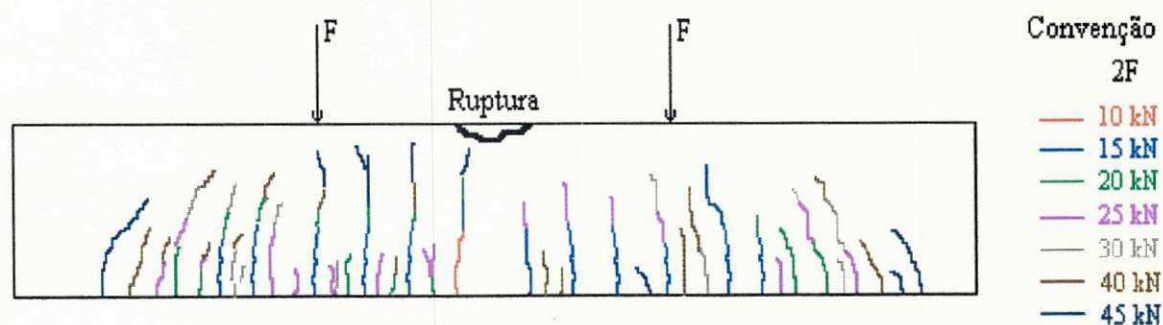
Evolução das Fissuras para a Viga VL-02
